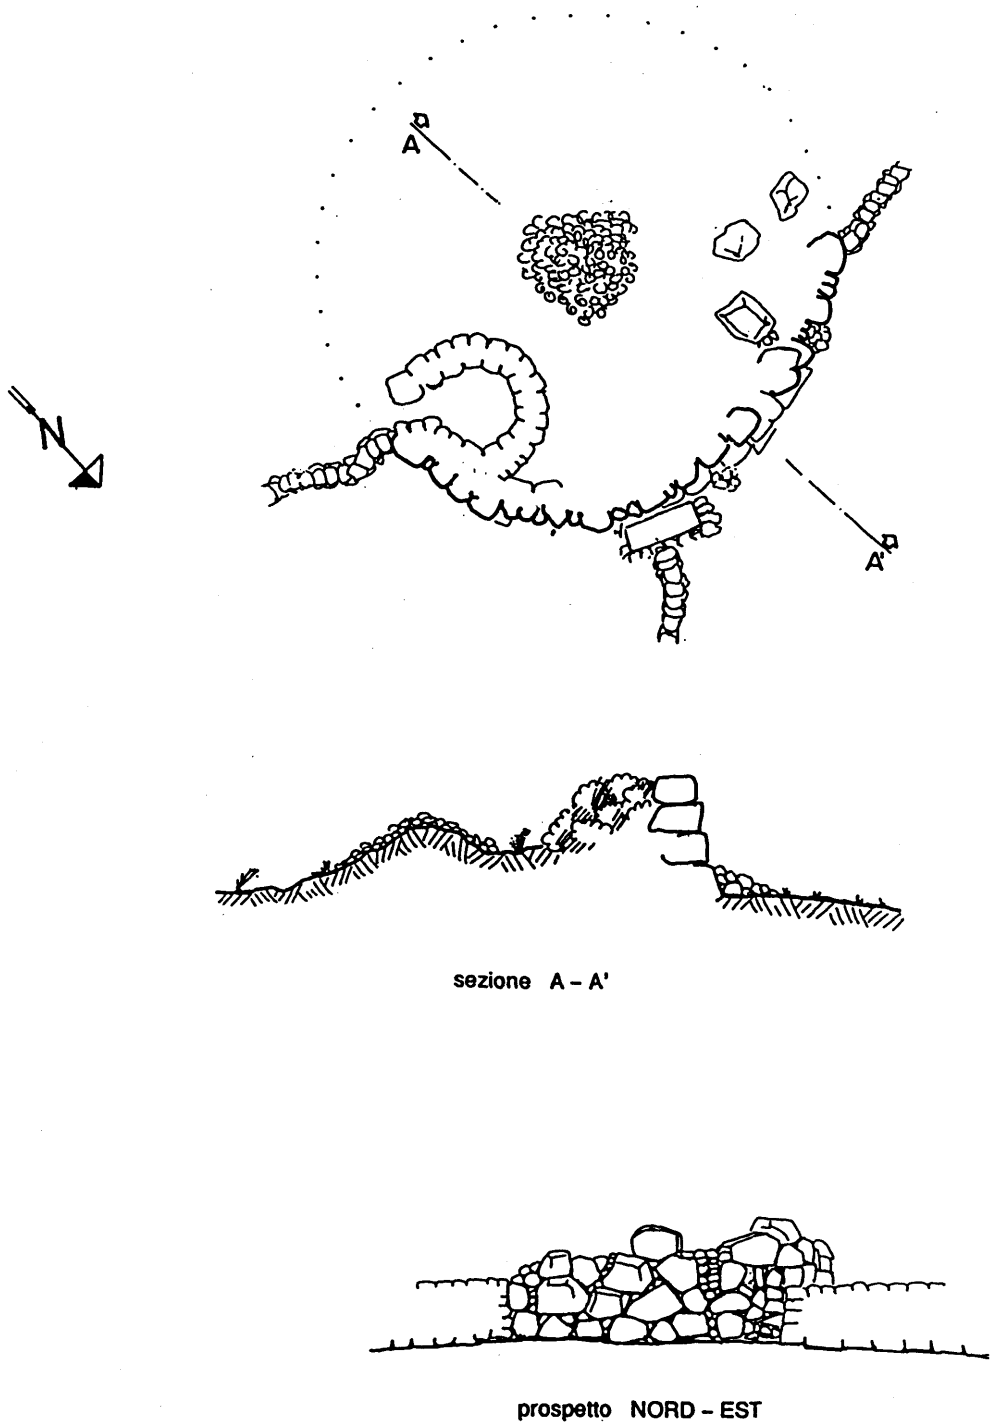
Nuraghe Cabones: planimetria, sezione, prospetto.
